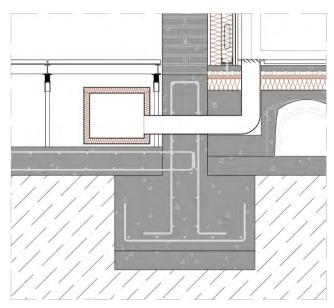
Detalle de la instalación exclusiva de ventilación.
